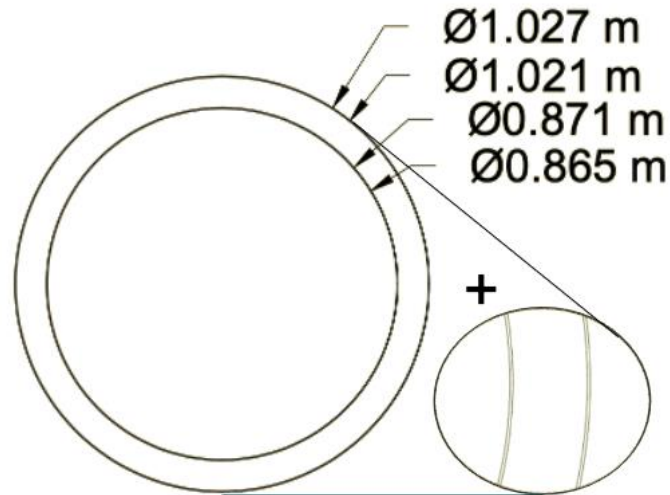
Sección hormigón con doble camisa de chapa - Fuente propia
